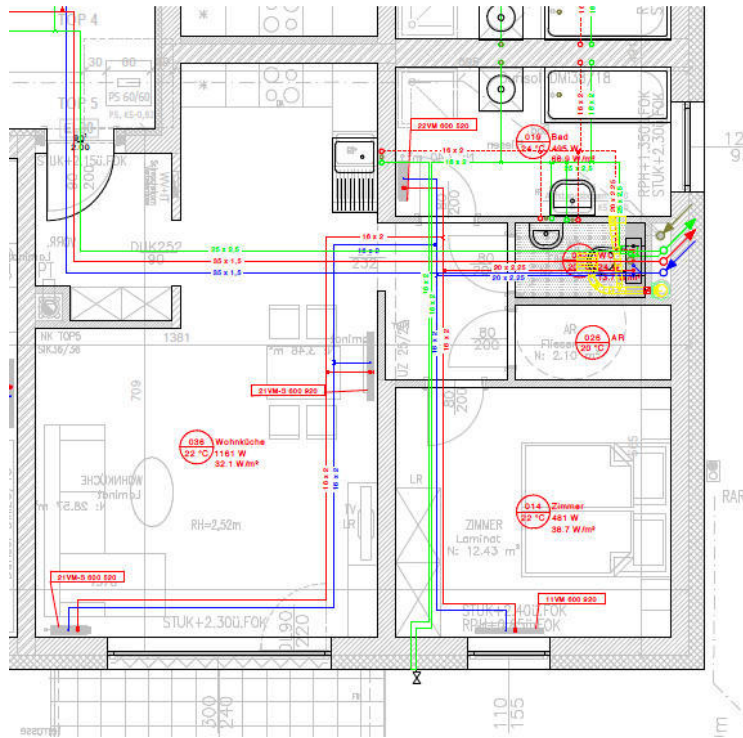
Heizungsverrohrung Projekt HK - Planausschnitt
